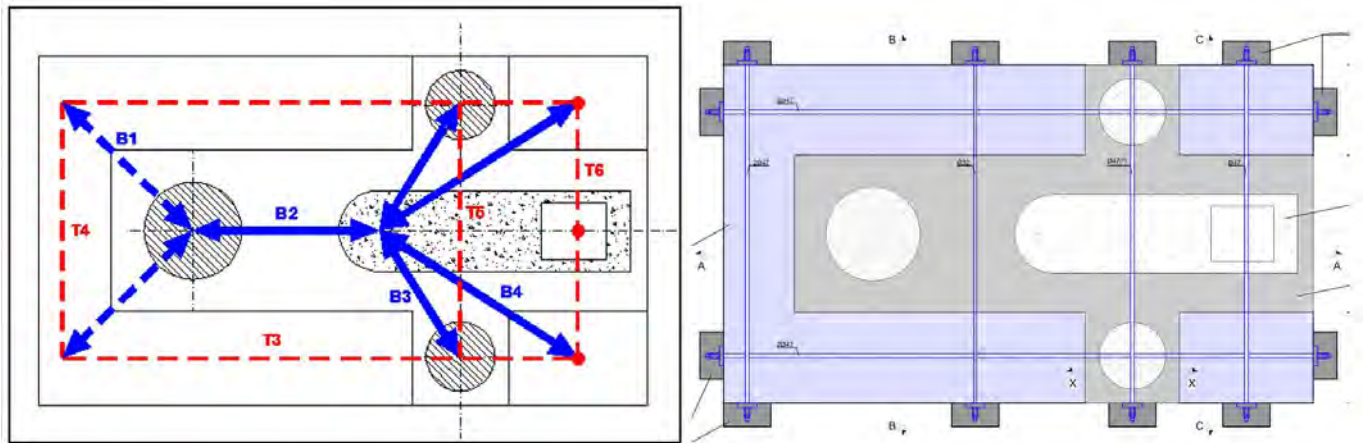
Planta del esquema de equilibrio del encepado reforzado (i) y ampliación y cosido con barras pretensadas del encepado.
